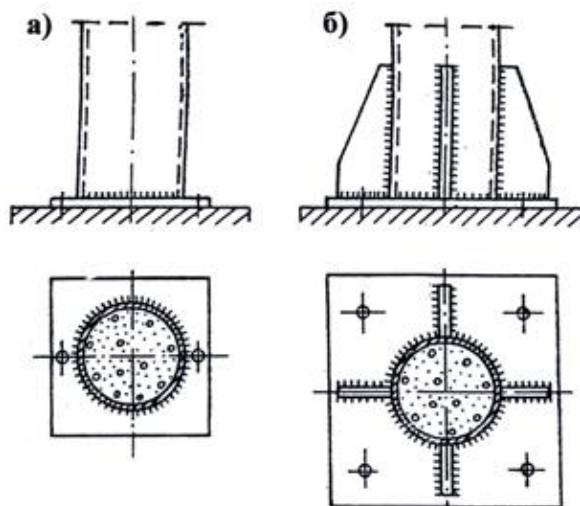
Конструкции баз центрально сжатых трубобетонных колонн с шарнирным (а) и жестким (б) опиранием [3]
